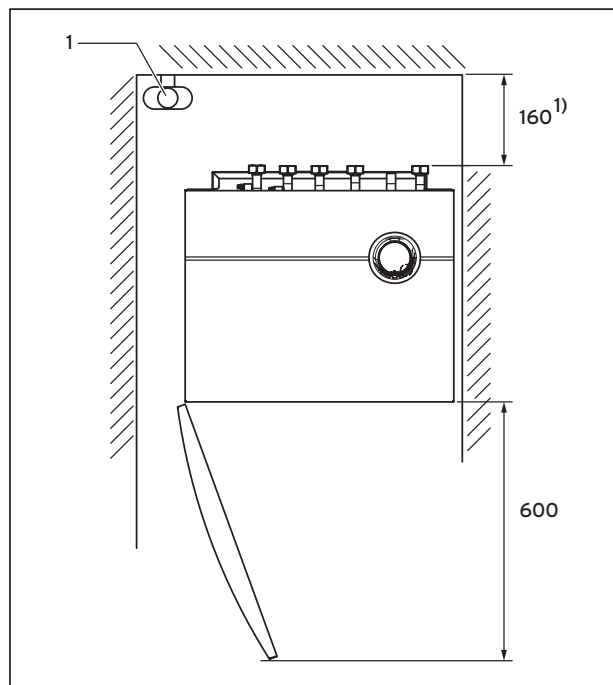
Distanțe la asamblare (dimensiuni în mm)
